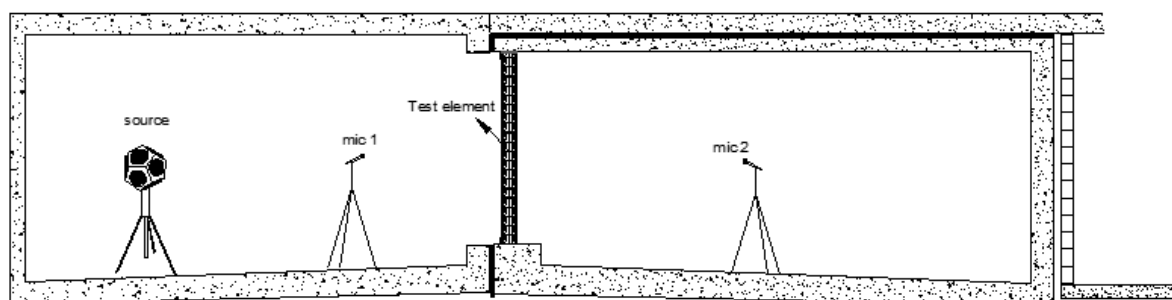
Vista em corte AA' das câmaras reverberantes do DEC-UC
